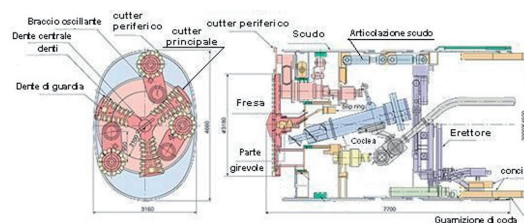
da [11] - Schema cinematico testa fresante e sezione longitudinale dello scudo.
